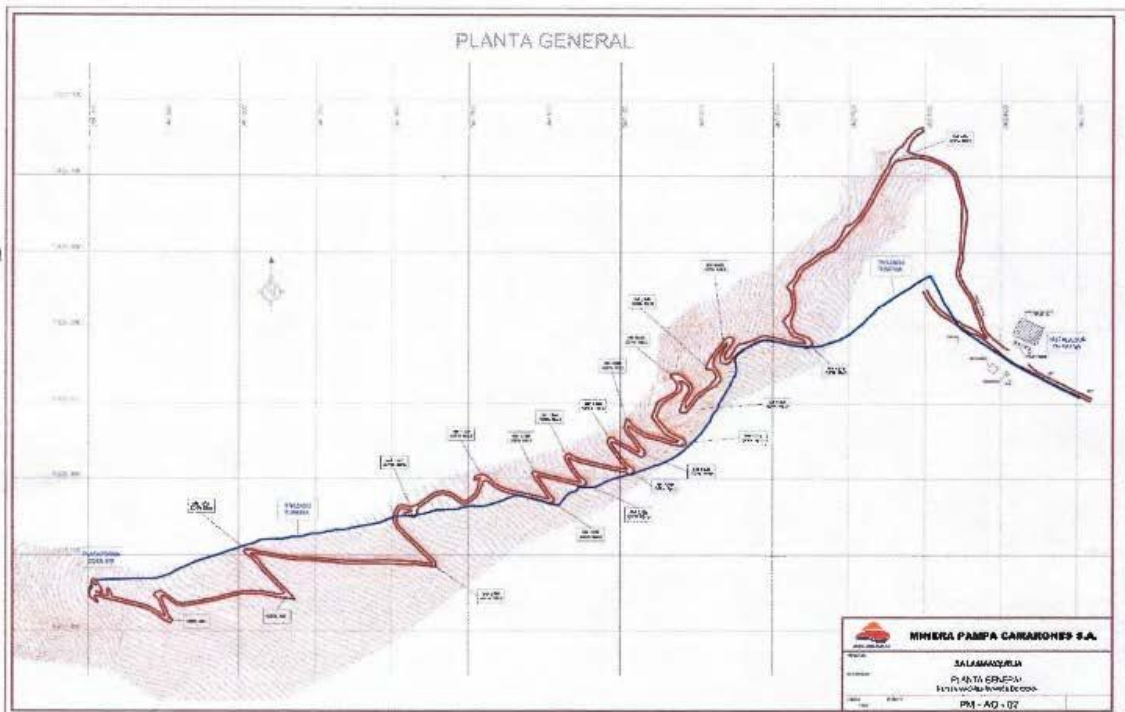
Planta General Proyecto SIAM desde Sector EB1 a Cota 1022 msnm.
